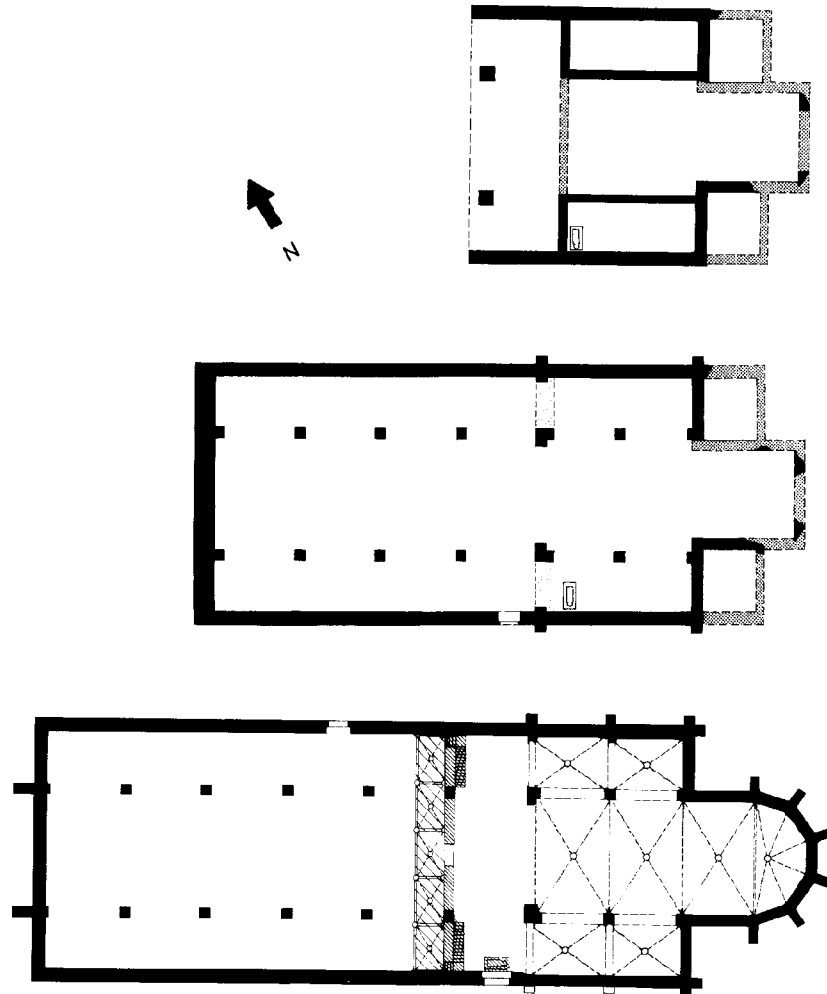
Basel, Predigerkirche: Provisorium (1236); Bau I (gegen 1250); Bau II (1264 geweiht); Grundrisse.
